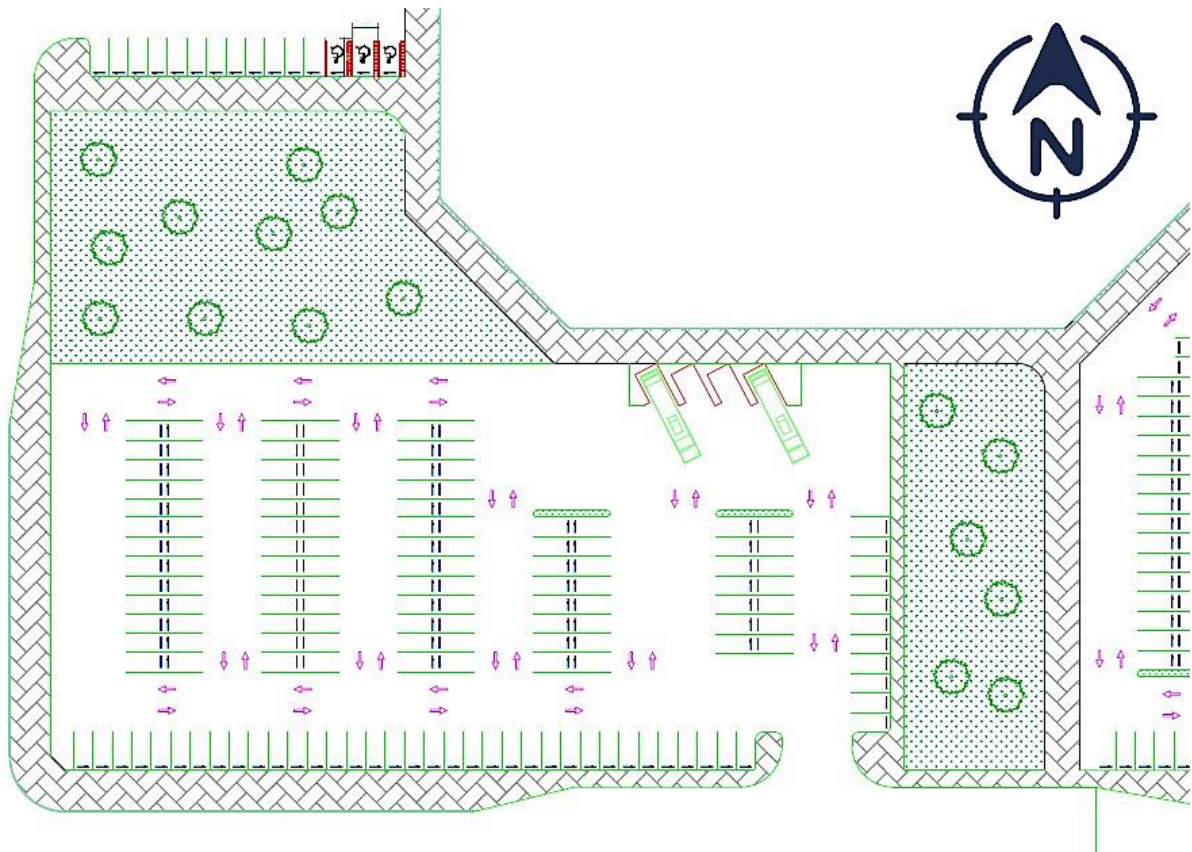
Vista en planta del estacionamiento para artistas y deportistas. Fuente: elaboración propia.
